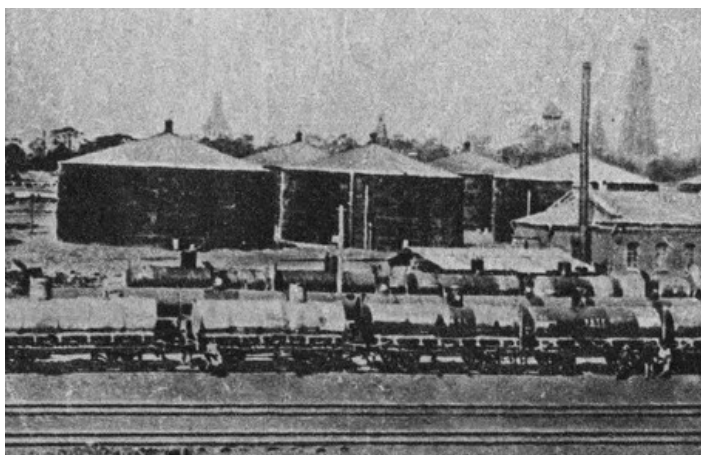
Резервуари конструкції Шухова і залізничні цистерни
